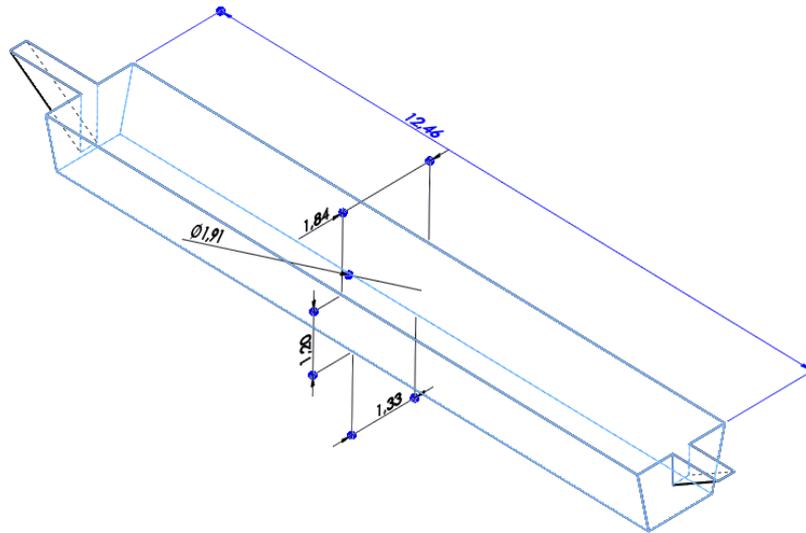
Esquema de excavación de la zanja Fuente: Autor
